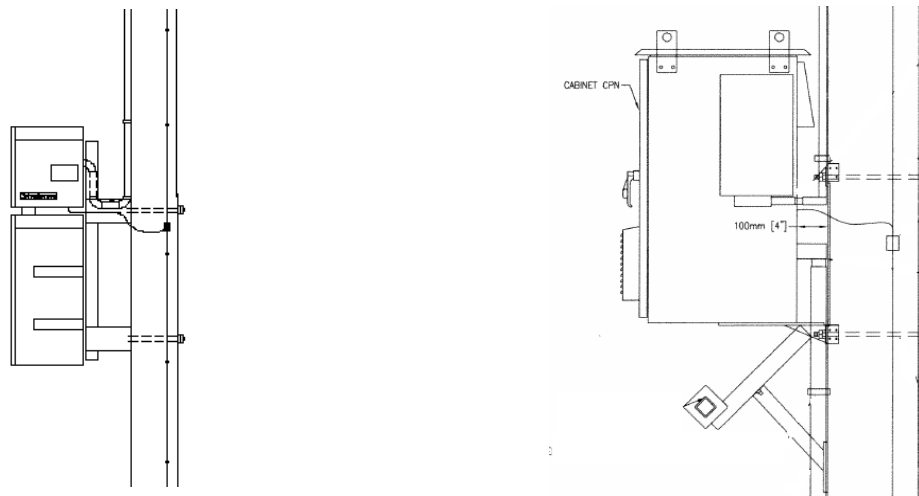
Montages types pour un cabinet de source d'alimentation sur poteau
